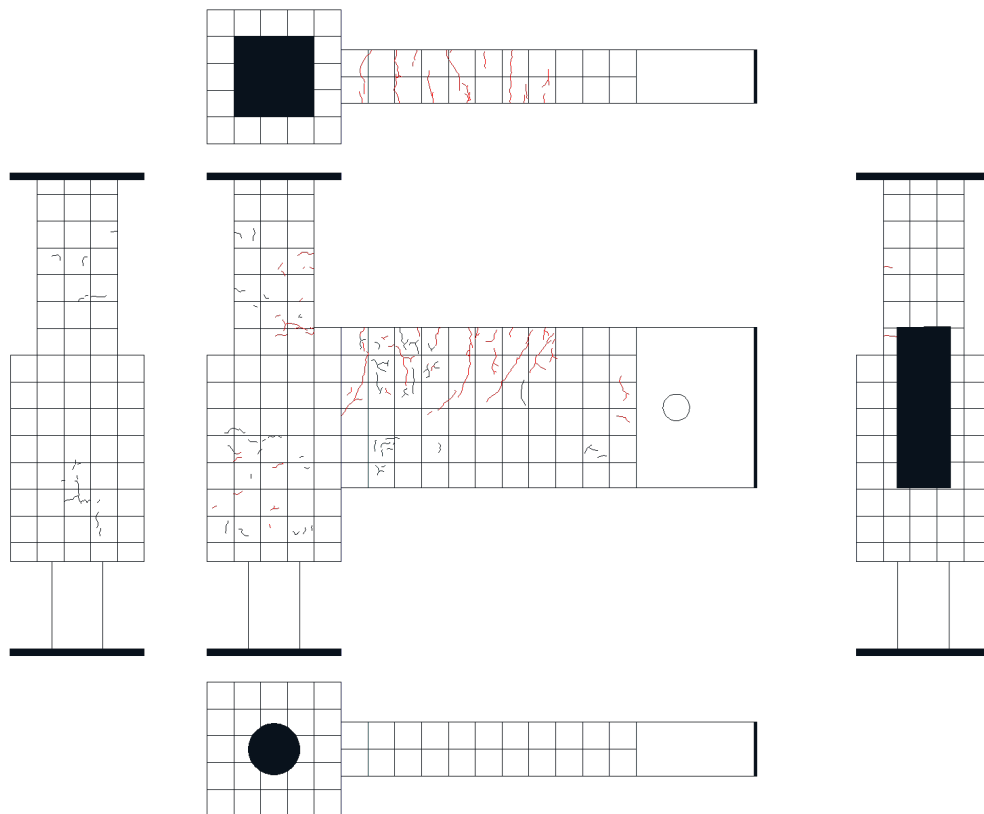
3. 164 試験体 D-1 ひび割れ状況 (1Cycle)
